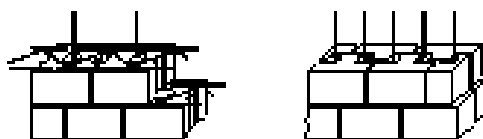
Tipi di unità per muratura armata ad armatura diffusa (3)
